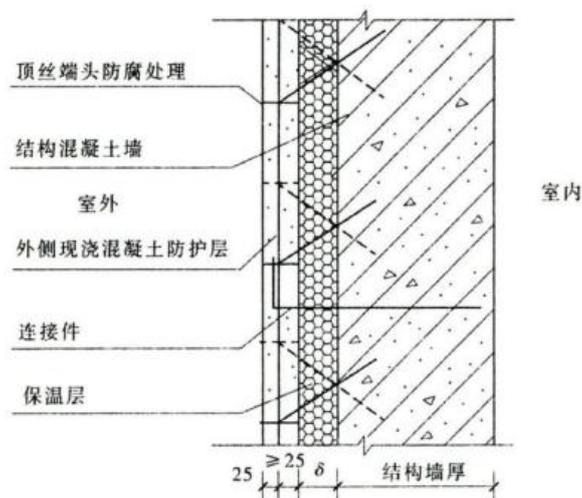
现浇混凝土内置保温墙体构造示意图（单位：mm）
